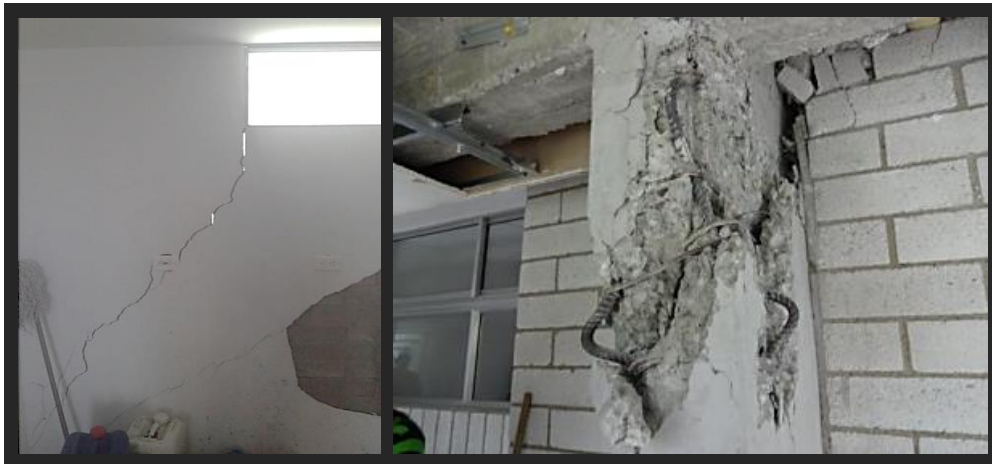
Grietas en la estructura de la torre 6 del edificio Space, antes de su colapso.
